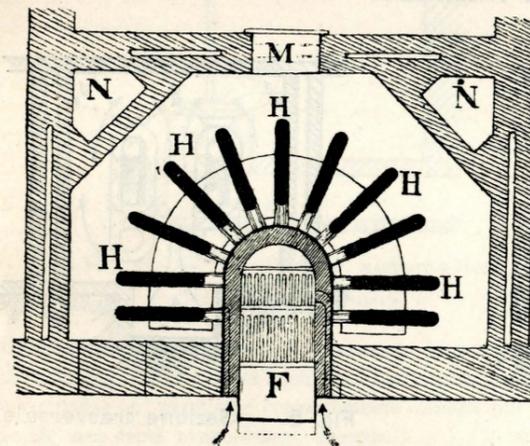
Pianta o sezione orizzontale passante pel piano della graticola.
